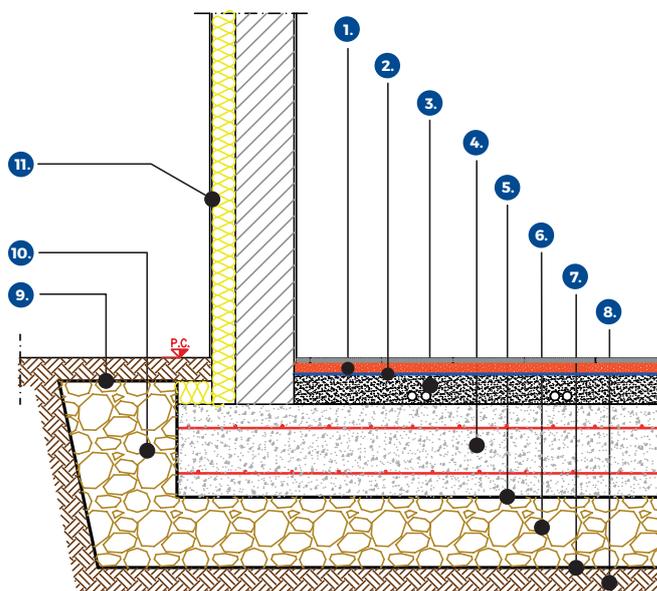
Isolamento sotto platea di fondazione con materiali granulari (argilla espansa o vetro cellulare): 1) Massetto di finitura, 2) Eventuale barriera al vapore, 3) Sottofondo alleggerito, 4) Platea di fondazione, 5) Tessuto non tessuto, 6) Vespaio isolato (argilla espansa o vetro cellulare), 7) Tessuto non tessuto, 8) Terreno livellato e cilindrato, 9) Tessuto non tessuto, 10) Strato isolante (argilla espansa o vetro cellulare), 11) Isolante.
